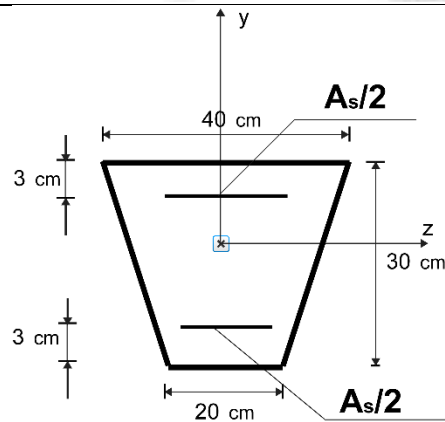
Seção trapezoidal e disposição das armaduras para o P2
